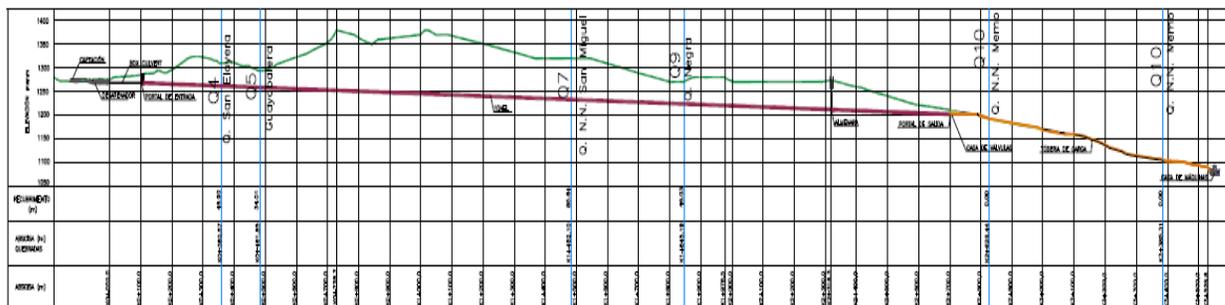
Perfil donde se muestra la profundidad en la que el túnel de conducción será construido
